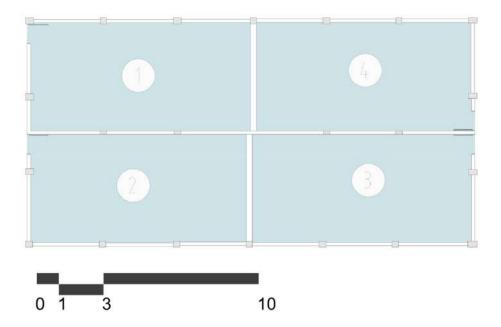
Planta 1 Bloque 58. Fuente: Equipo de diagnóstico.
